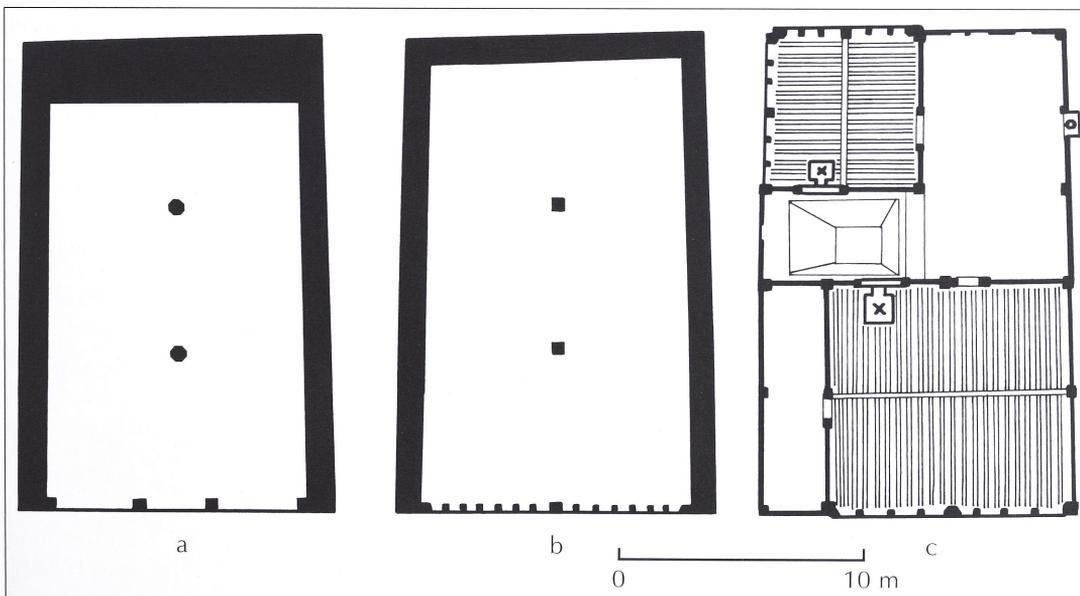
Veringenstadt, Rathaus. Rekonstruktion der mittelalterlichen Grundrissgliederung. Genodet, M. 1 : 300. a Erdgeschoss; b 1. Obergeschoss; c 2. Obergeschoss.
